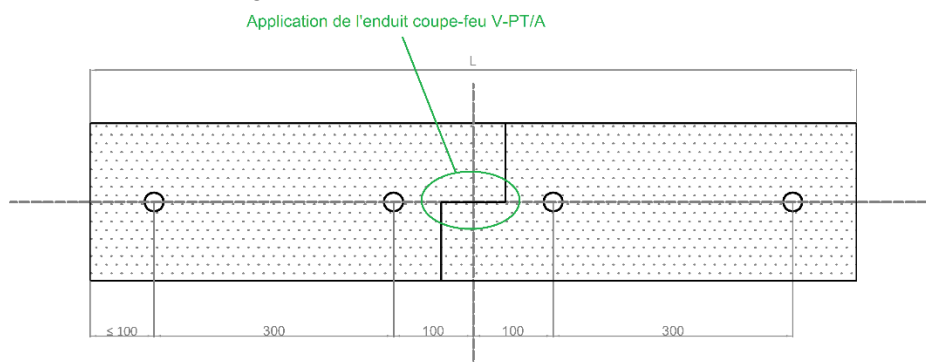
Mise en œuvre des ressorts d'ancrage dans les panneaux LINEARIS, avec raccord, côté dalle et collage de l'emboîtement (vue de face)
